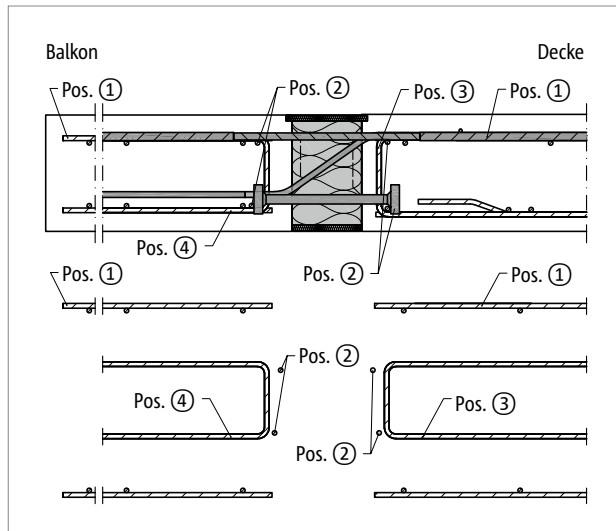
Schöck Isokorb® XT Typ KP-M11: Bauseitige Bewehrung bei indirekter Lagerung
